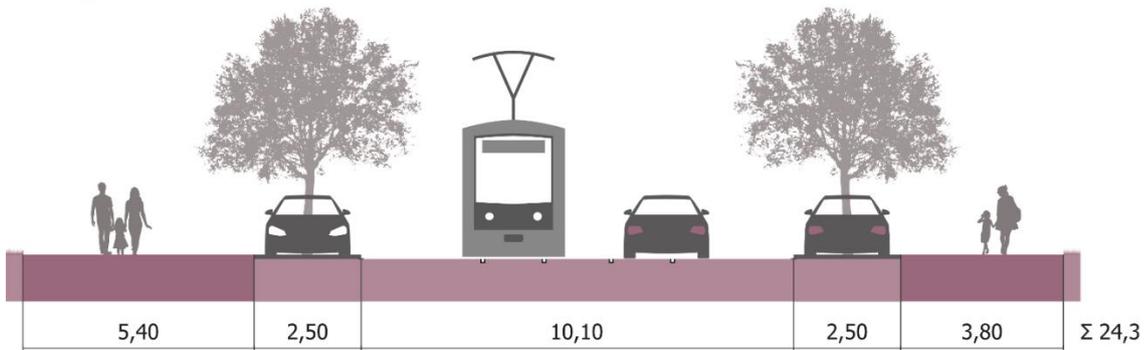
Regelquerschnitt 02, Wallensteinstraße Streckenbereich, Bestand und Planung
